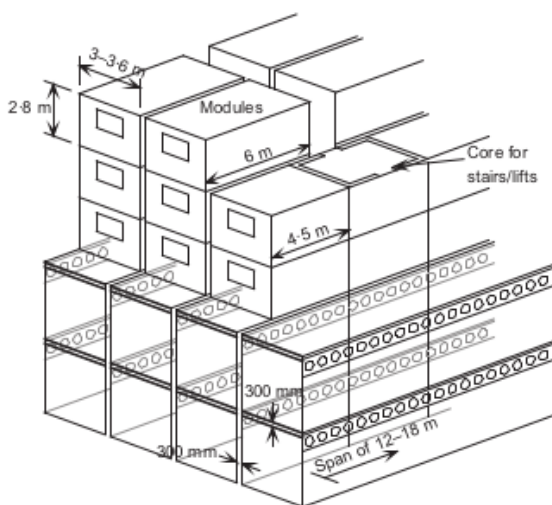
Sistema de podio de 2 plantas bajo una construcción modular multiplanta. Fuente: (Lawson and Richards 2010)
